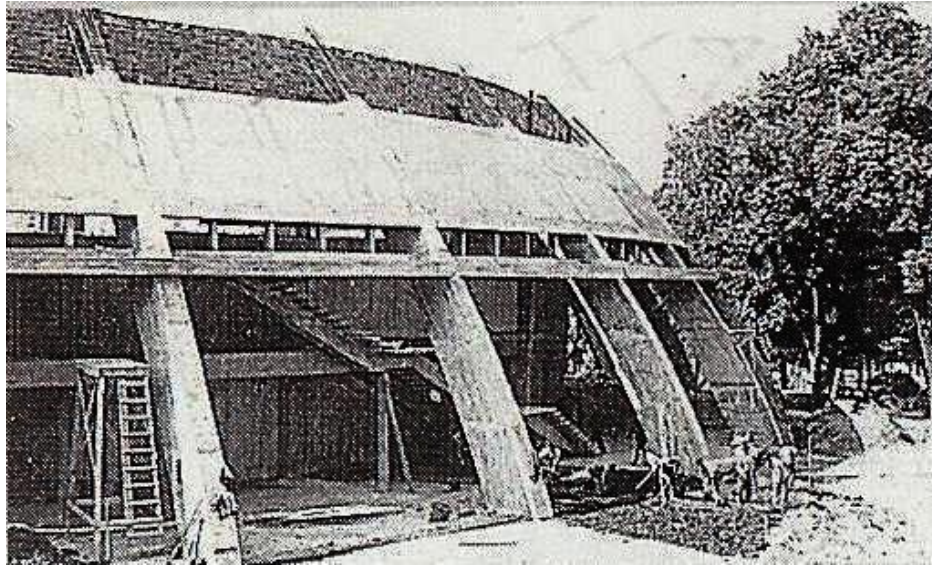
Pavilhão Rosa Mota após a primeira fase de execução,
